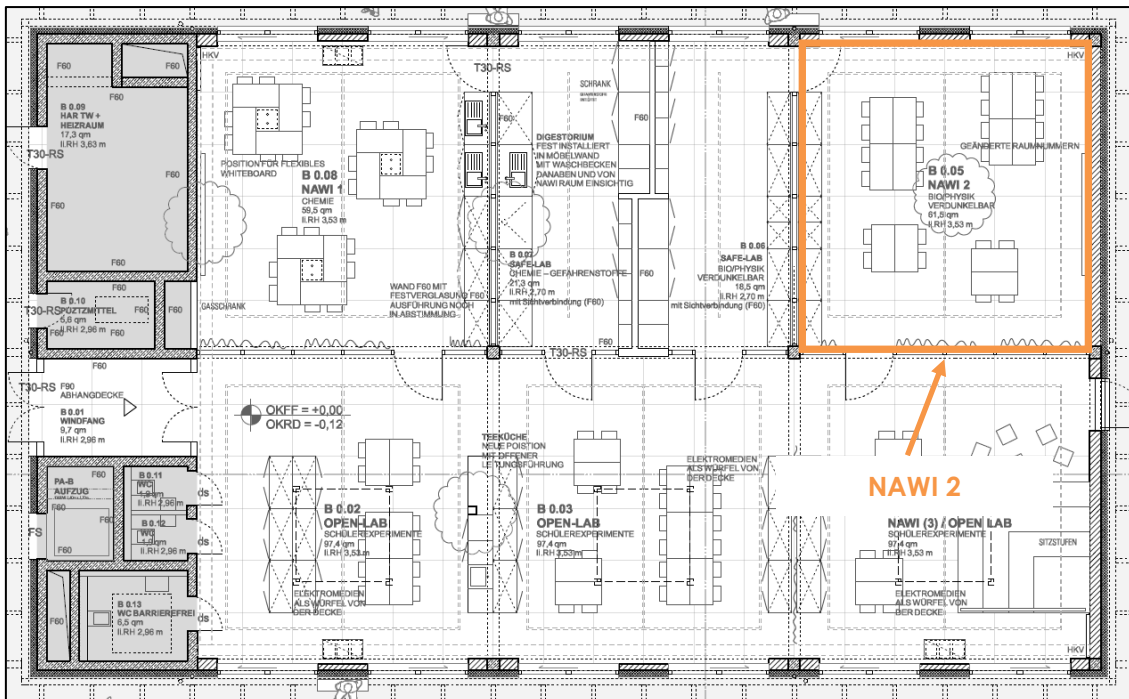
Lernhaus Oberstufe, Grundriss EG, unmaßstäblich /13/
